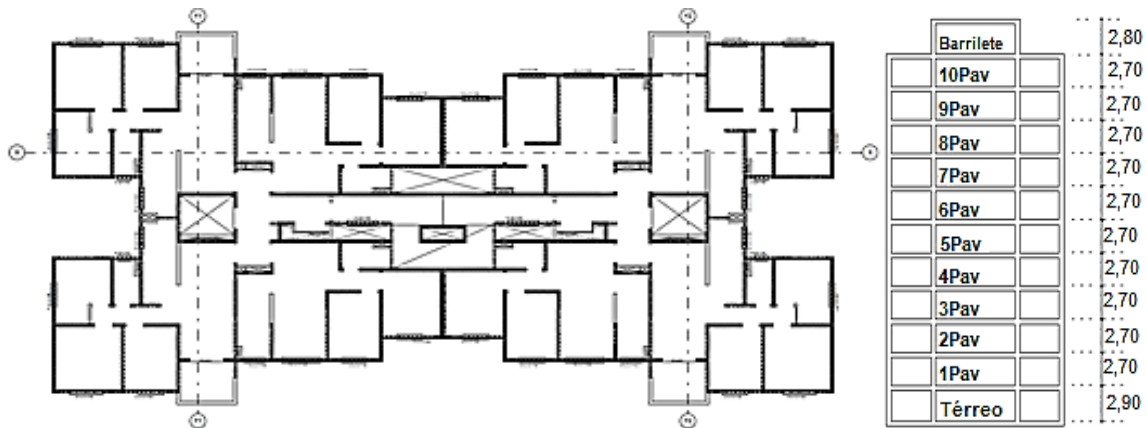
Modulação do pavimento tipo e corte esquemático da edificação.
